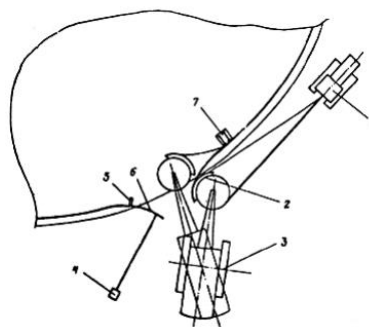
Формообразование полотнища стенки по высоте: 1 - тяговый трактор; 2 - приспособление для формообразования; 3 - кран; 4 - инвентарный якорь; 5 - упор; 6 - формообразованный участок полотнища; 7 - стойка-упор [16]
